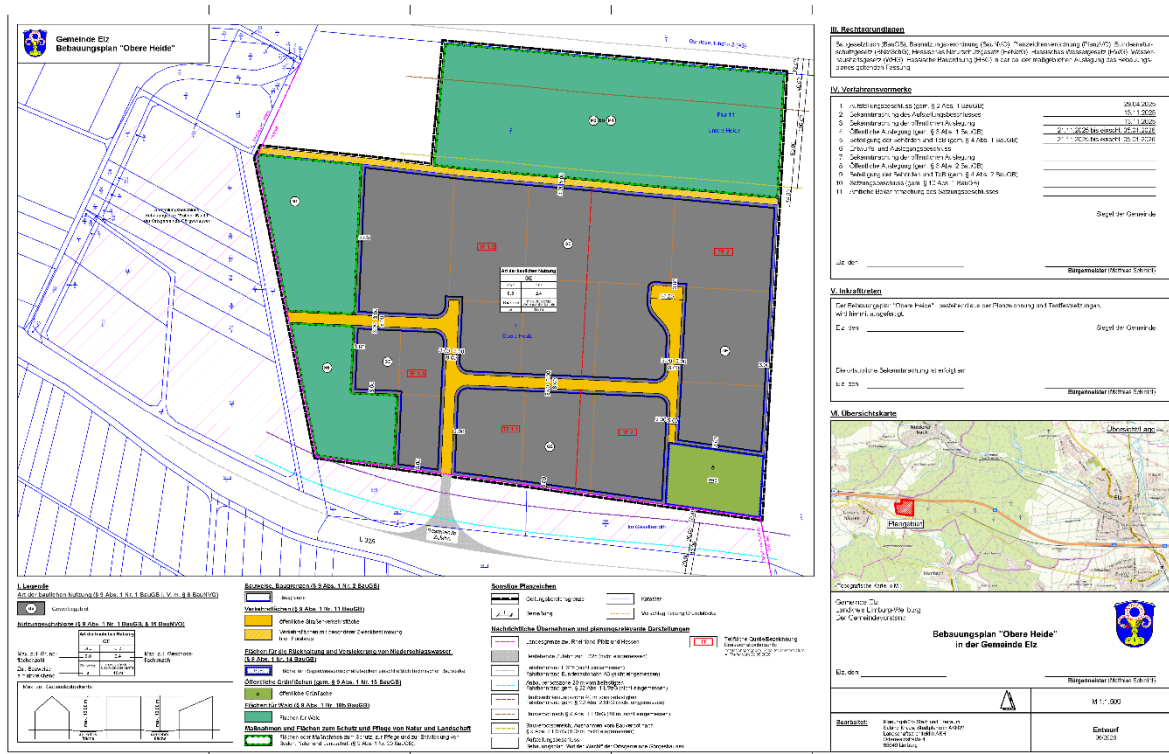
Bebauungsplan „Obere Heide“ Gemeinde Elz, Kraus 2026
